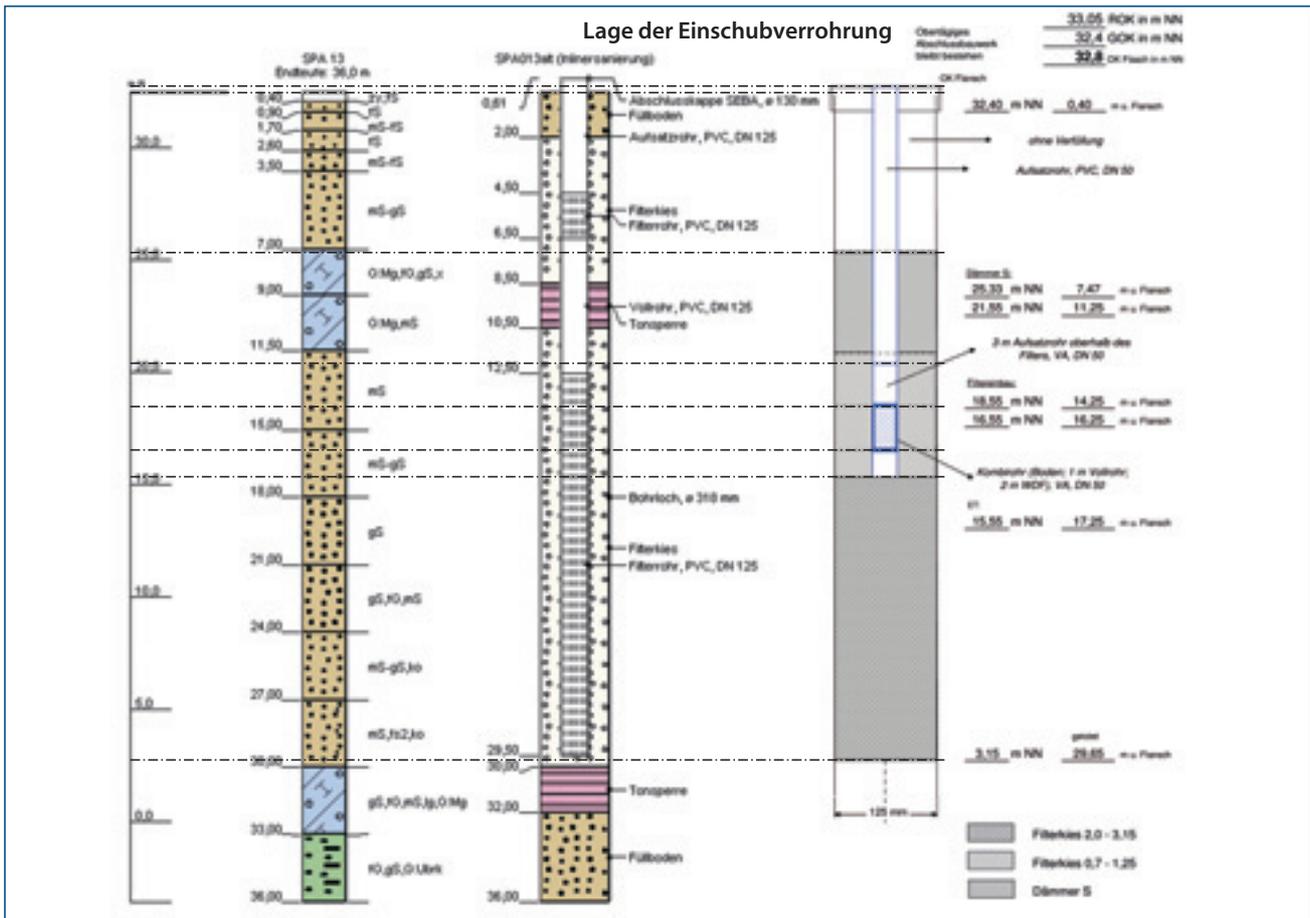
Ausbauezeichnung einer Messstelle mit hydraulischem Kurzschluss; Umbauzeichnung Inline-Sanierung (rechts)
